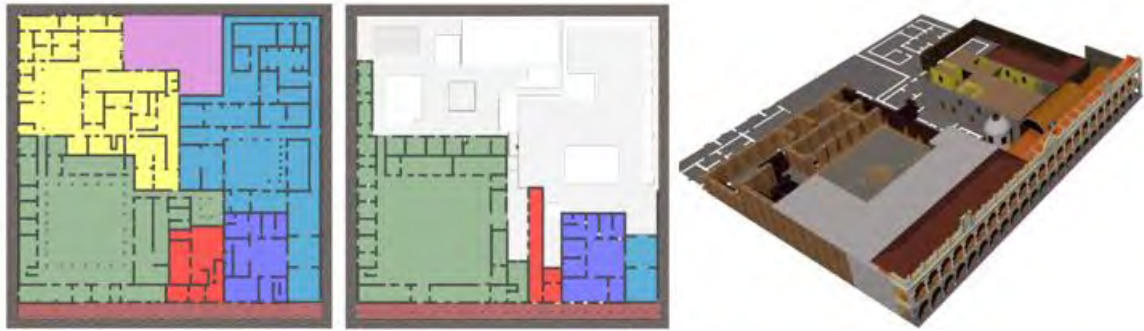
Planta baja al a izquierda, planta alta al centro, vista 3D a la derecha.
